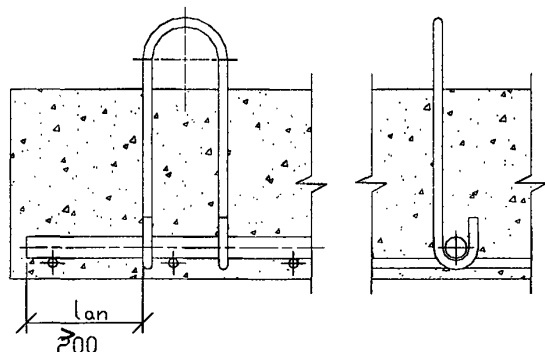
Схема расположения петли в многопустотной плите перекрытия (армирование плиты условно не показано)
